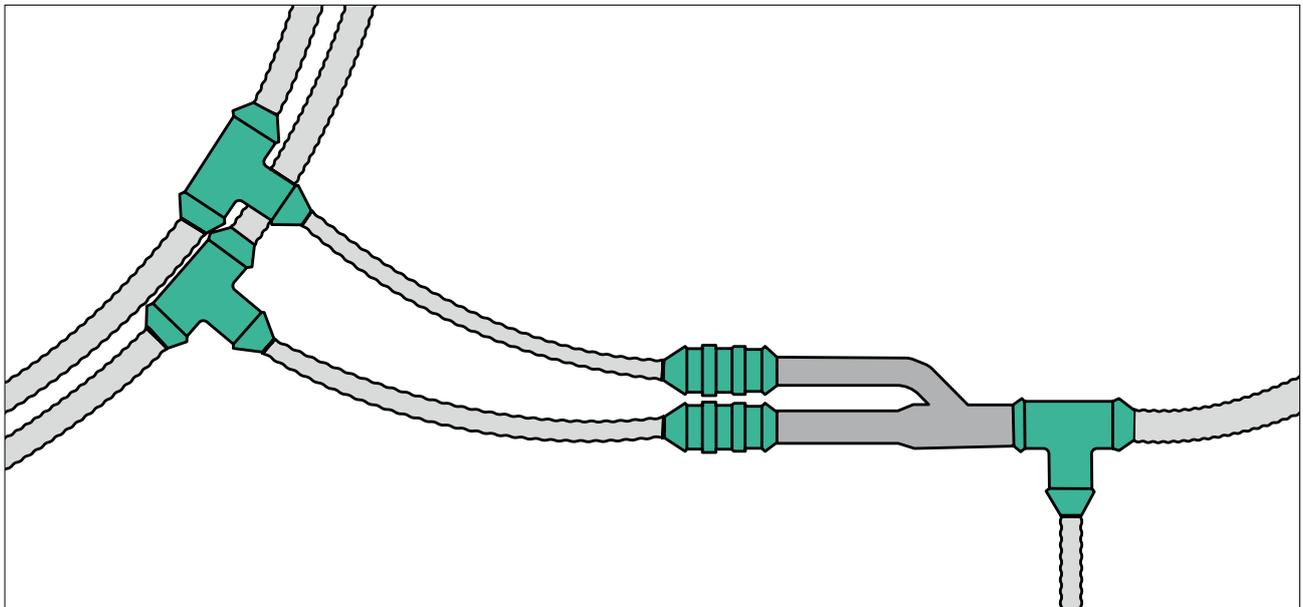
Installationsschema/Komponenten für Abzweig mit Hosenrohrverbindung (Draufsicht)
